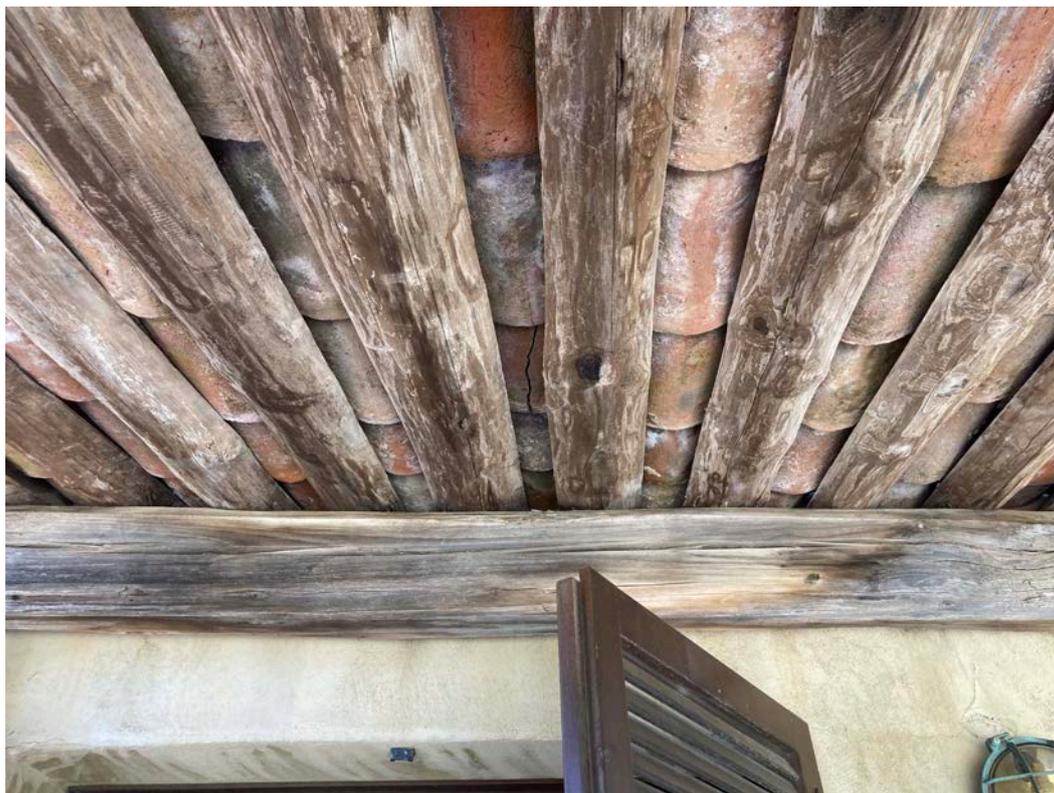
particolare ammaloramento tettoia nel terrazzo al Piano Terra
